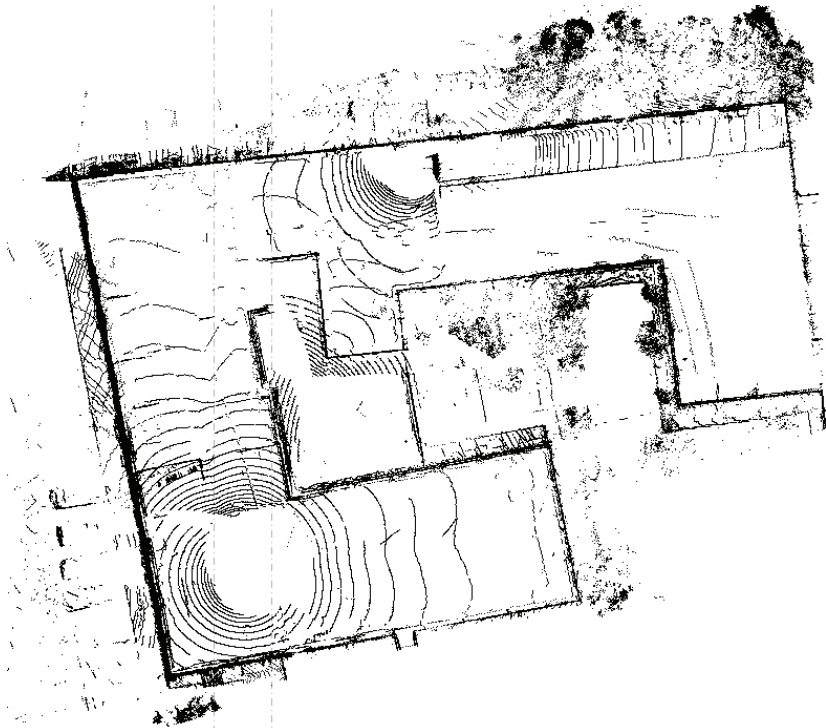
Konturet e planimetrive të kateve të objektit në 3D
